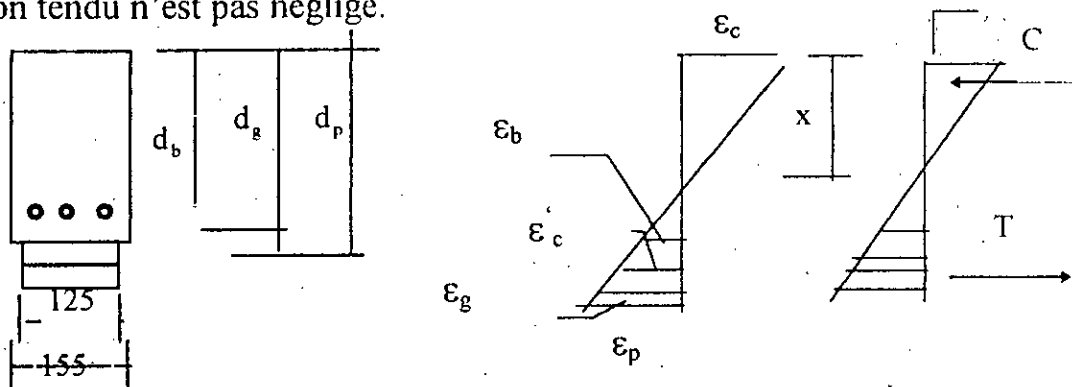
Dimensions de la section droite de la poutre et diagrammes de déformation et de contraintes
